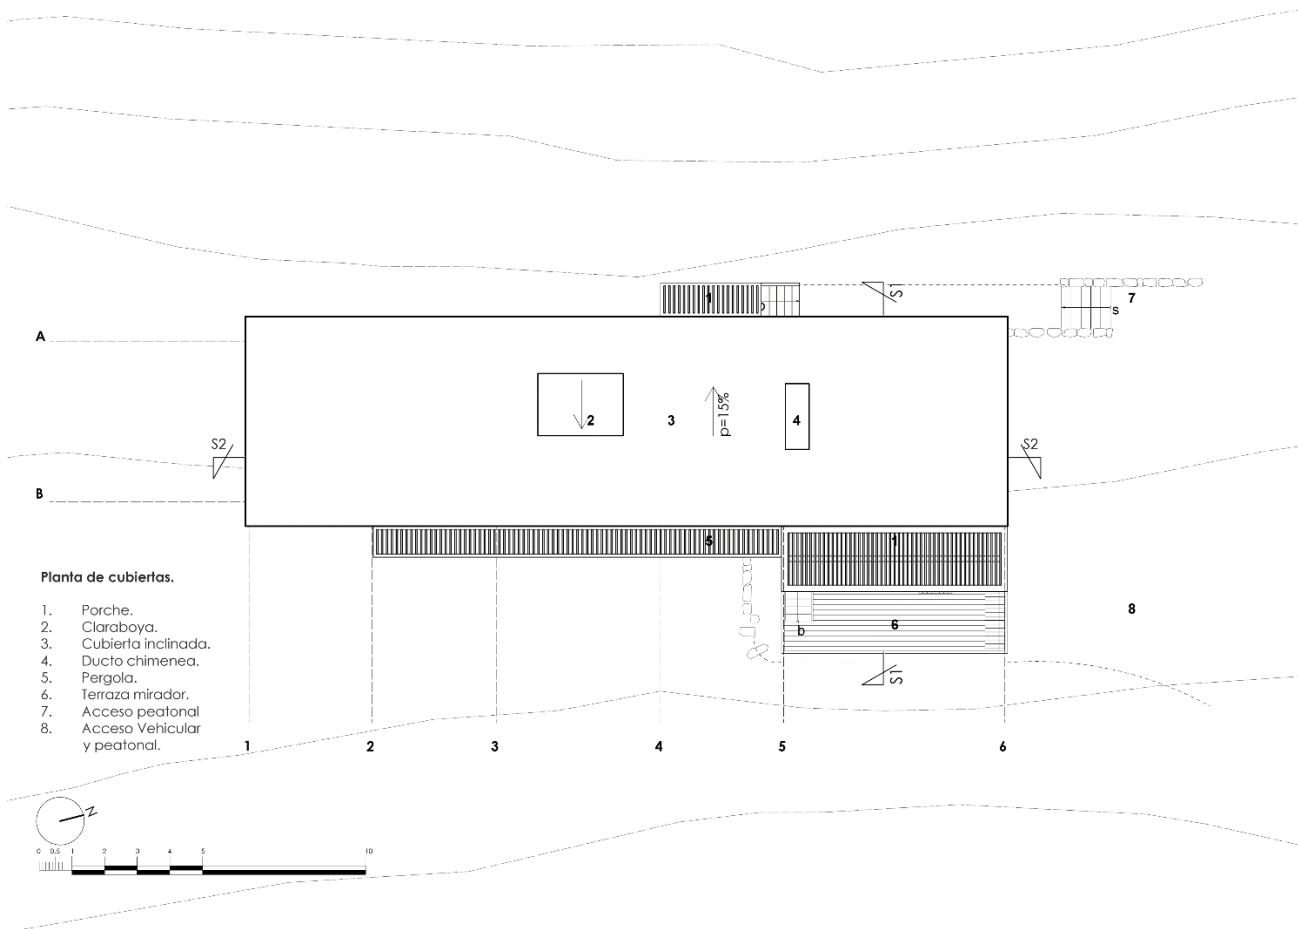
Planta de cubiertas y accesos. Fuente: Autor.
